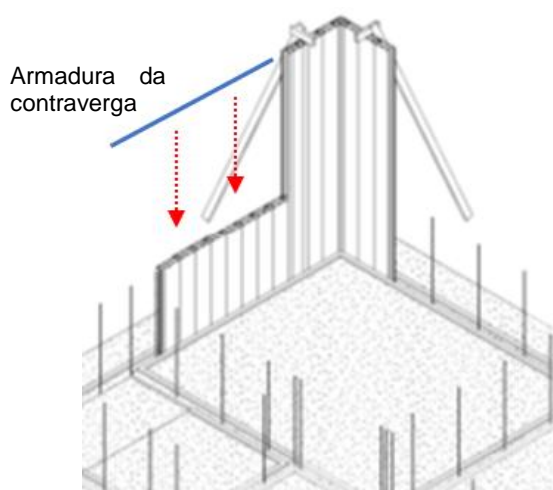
Posicionamento da barra da armadura horizontal da região da contraverga nos furos das nervuras dos perfis (topo dos peitoris).
